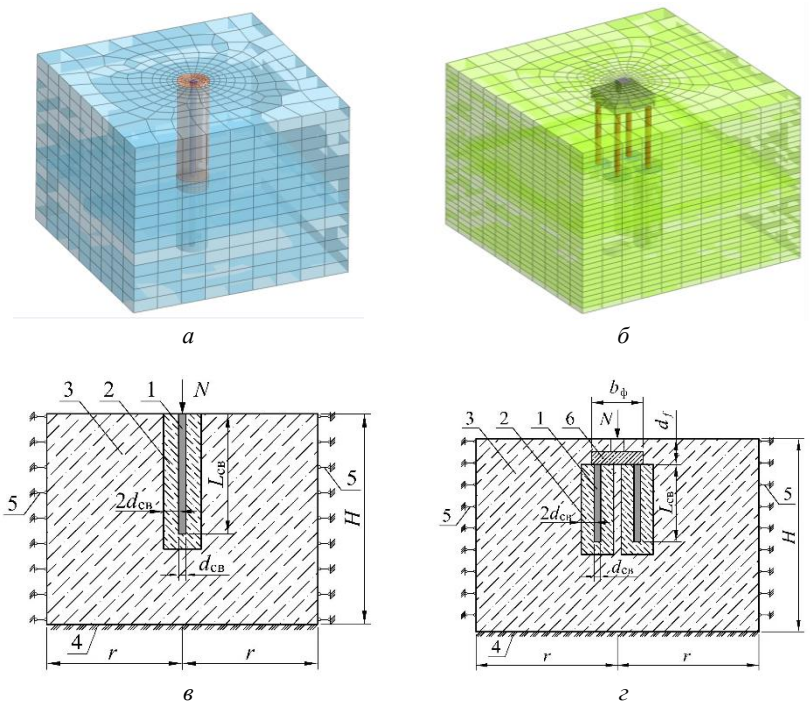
Моделирование в ПК *Midas GTS*: а, в – соответственно общий вид расчетной системы и расчетная схема одиночной инъекционной сваи; б, г – то же для усиливаемого фундамента; 1 – инъекционная свая; 2 – уплотненный грунт (в пределах $2d_{св}$ от ствола сваи); 3 – массив грунта (мягкопластичный суглинок); 4 – жесткое закрепление (исключаются все перемещения); 5 – шарнирное сопряжение (по боковой поверхности возможны вертикальные перемещения); б – отдельный фундамент мелкого заложения; $L_{св}$ – длина сваи; $d_{св}$ – диаметр сваи; H – высота массива грунта; r – половина ширины основания массива грунта; b_ϕ – ширина отдельного фундамента мелкого заложения; d_f – глубина заложения подошвы отдельного фундамента мелкого заложения
